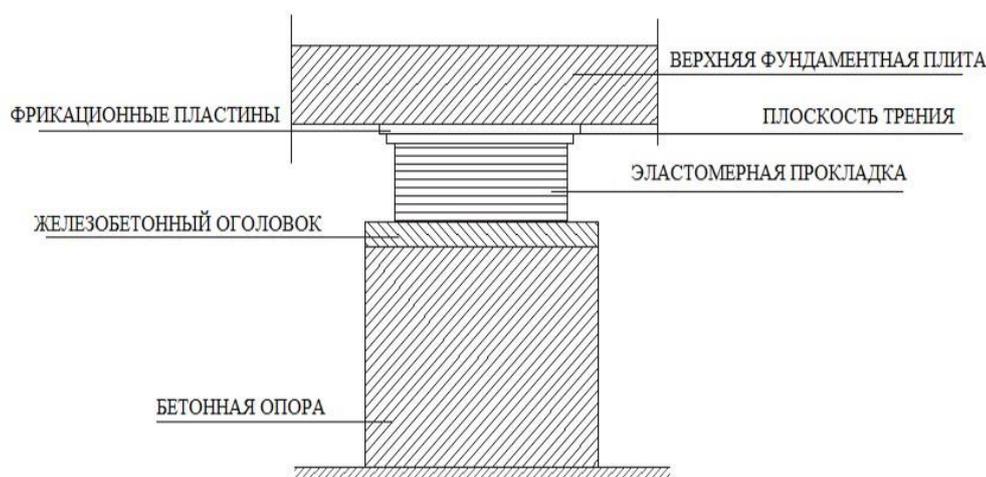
Сейсмоизолирующий фундамент фирмы Spie Batignolle
